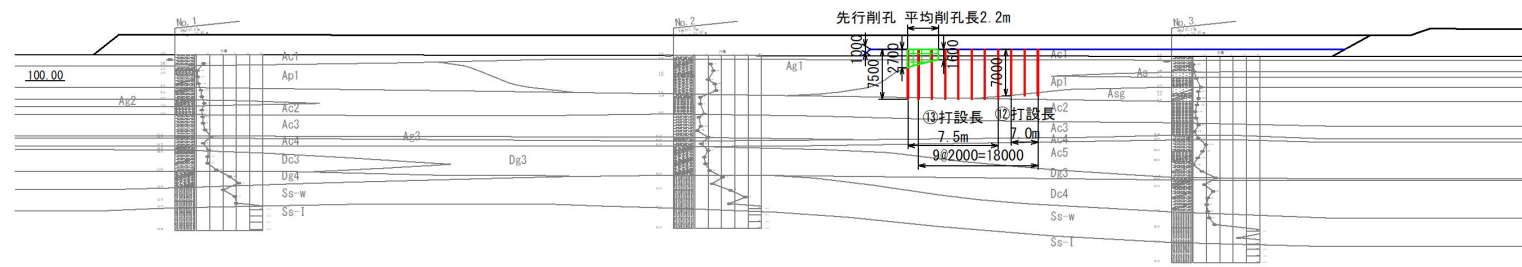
地盤改良一般図(2期施工) (プラスチックボードドレーン)
